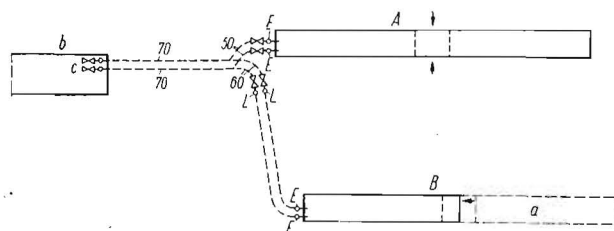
Lageplan der Kükenaufzuchtanlage in der LPG Bahragrund in Behrungen; A und B Kükenställe aus je 2 Stalleinheiten, die Errichtung der zweiten Stalleinheit a des Gebäudes B ist für die Perspektive vorgesehen, b Technik-Gebäude, c Heizkessel; E Entleerung, L Lüftung
